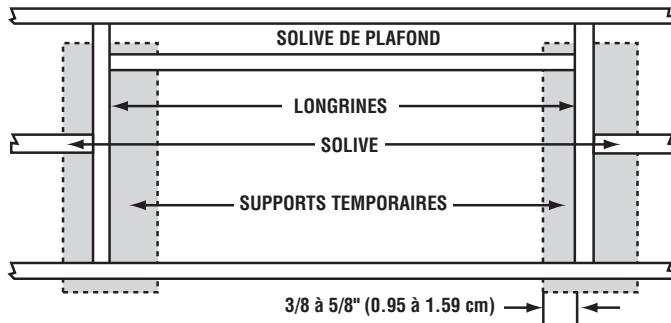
OUVERTURE ENCADRÉE AVEC PLANCHETTES DE SUPPORT TEMPORAIRE PRÈTÉE À RECEVOIR L'ESCALIER
